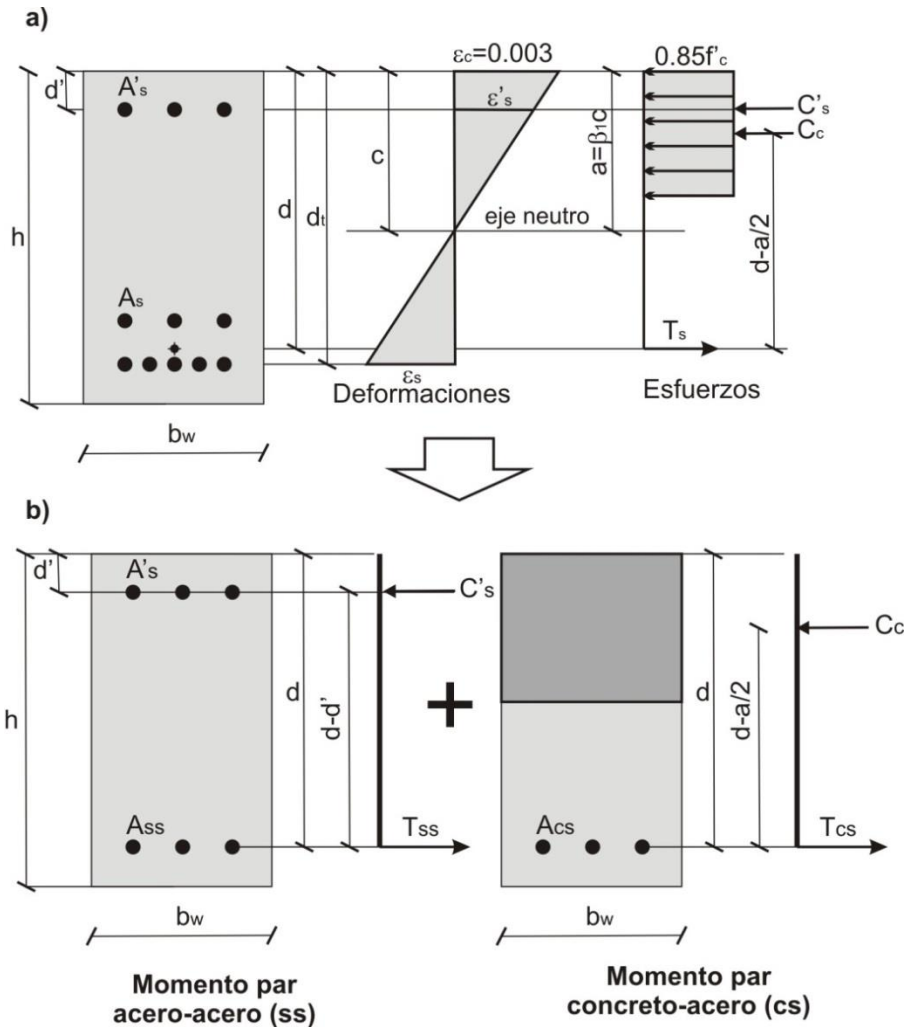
a) Sección en una viga con refuerzo a tensión-compresión.
